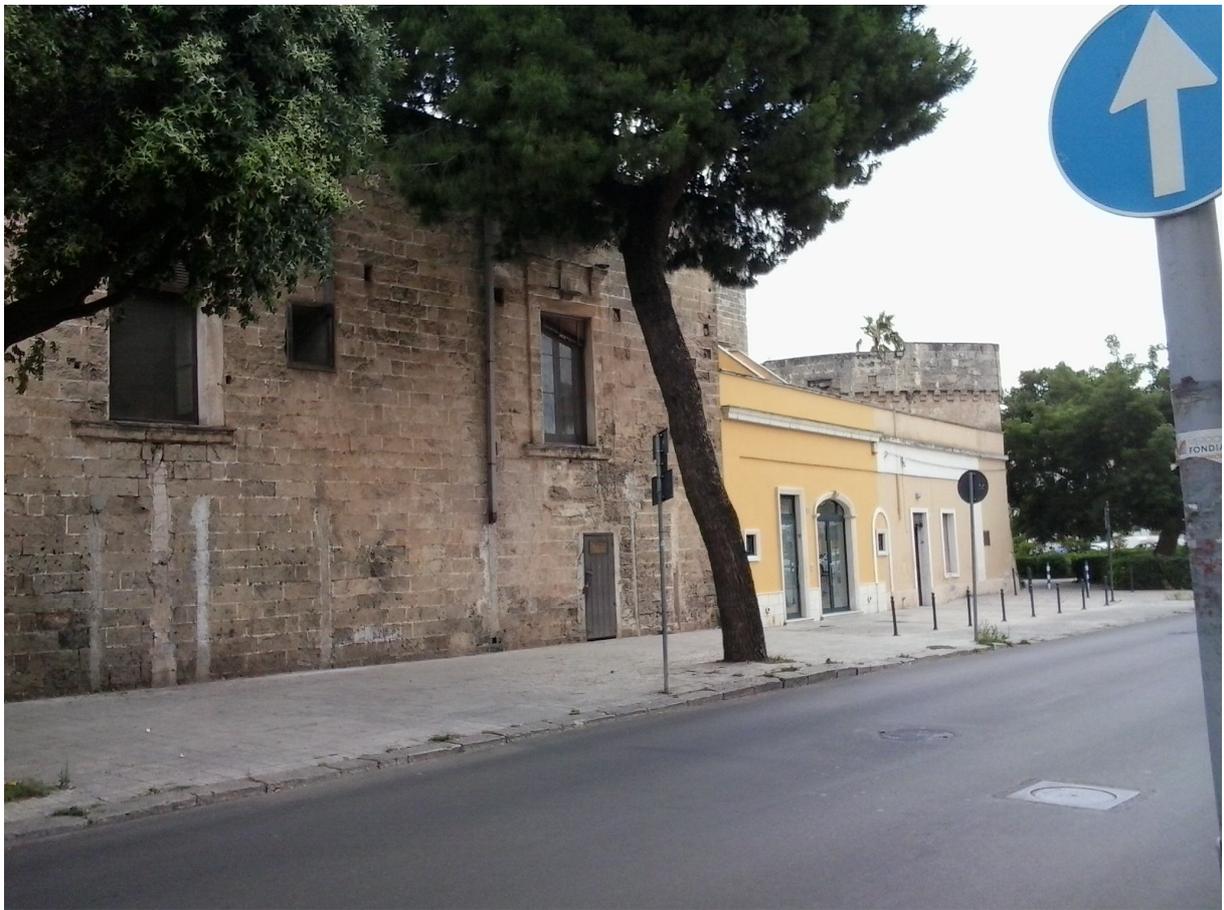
Vista prospetto Via Roma - Lato Piazza Diaz
